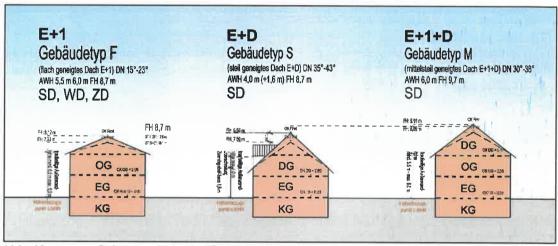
Schemaschnitt der Gebäudetyp F, Gebäudetyp S und Gebäudetyp M
